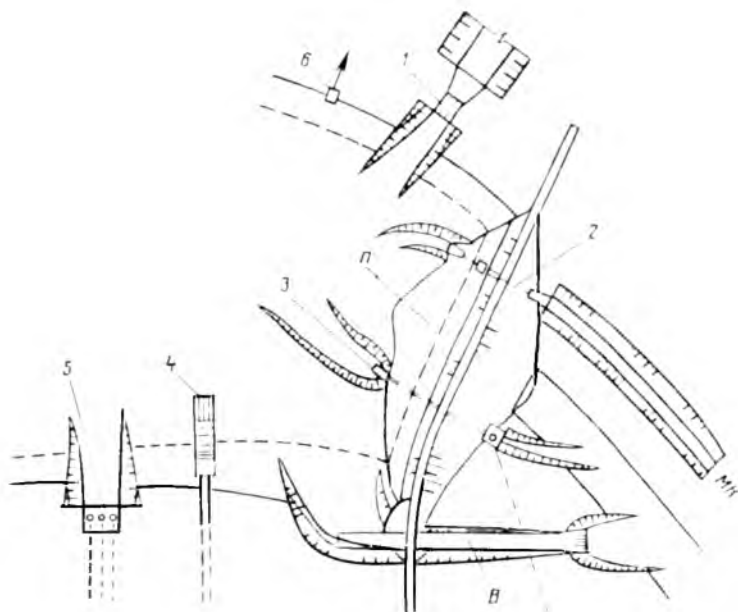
Возможные типы водозаборов при водохранилищном гидроузле:
